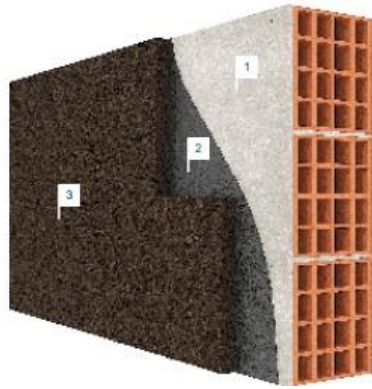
Revestimento de fachada com cortiça à vista na *The Cork House* (www.the-cork-house.com)
